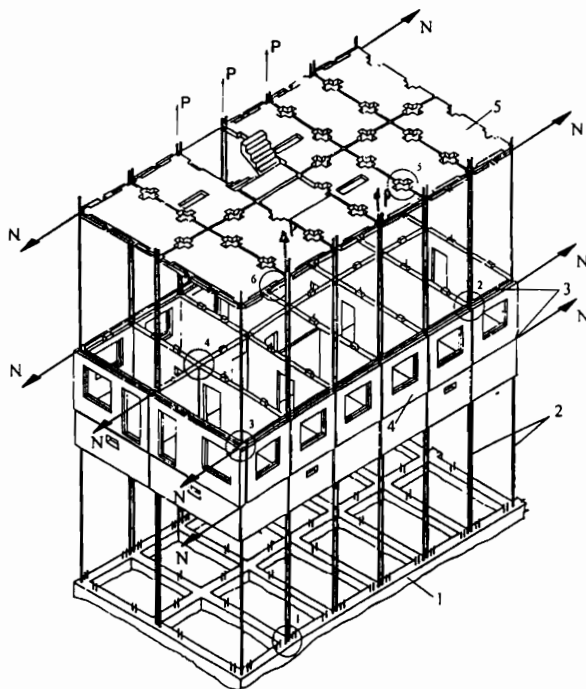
Конструктивная схема крупнопанельного здания с напрягаемой арматурой и шпоночным соединением элементов: 1 – фундамент здания с анкерной арматурой; 2 – напрягаемая арматура вертикальных стыков панелей; 3 – то же, горизонтальных стыков; 4 – наружные стеновые панели; 5 – панели перекрытия на комнату со шпоночным соединением; N, P – усилие натяжения для горизонтальных и вертикальных стыков
